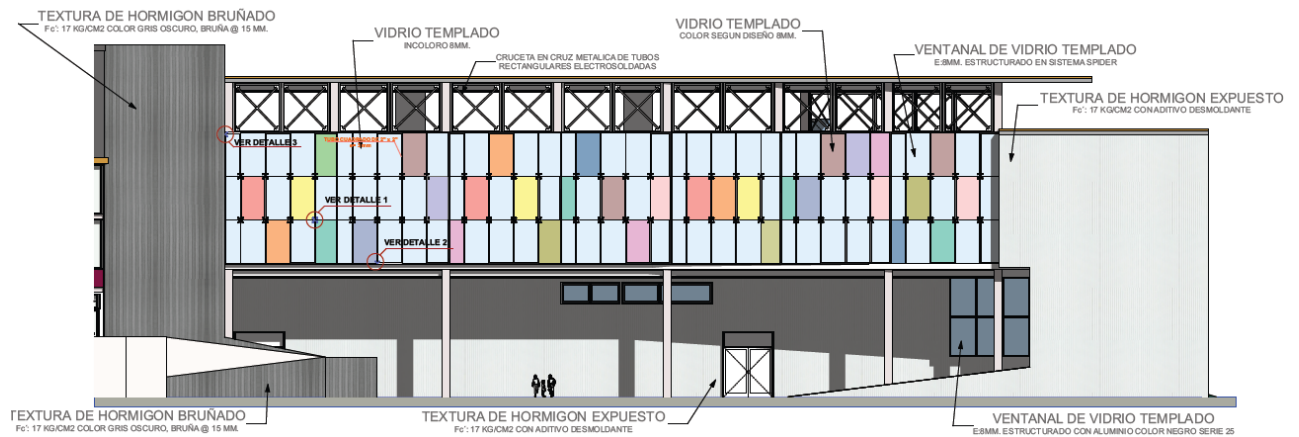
Elevación Muro Cortina Fuente: Elaboración Propia
